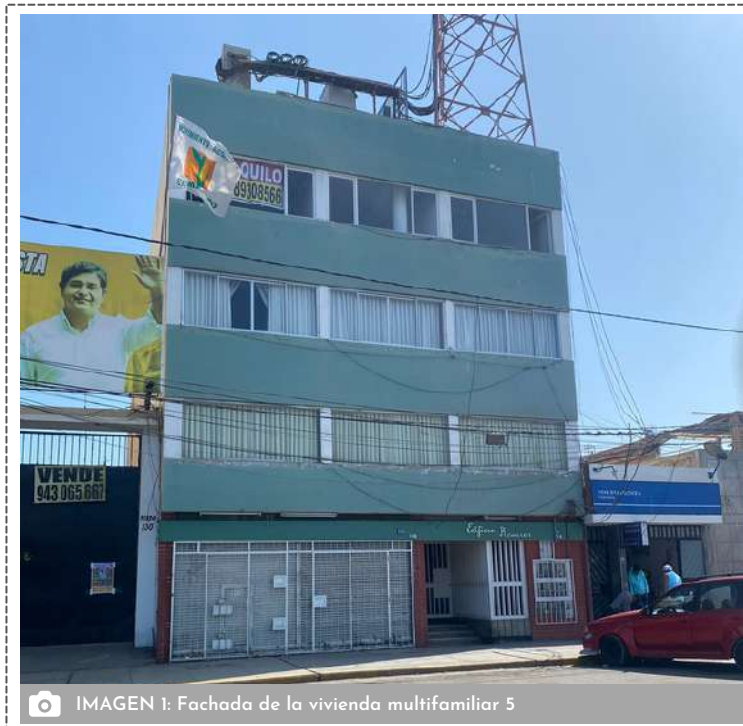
Fachada de la vivienda multifamiliar 5
